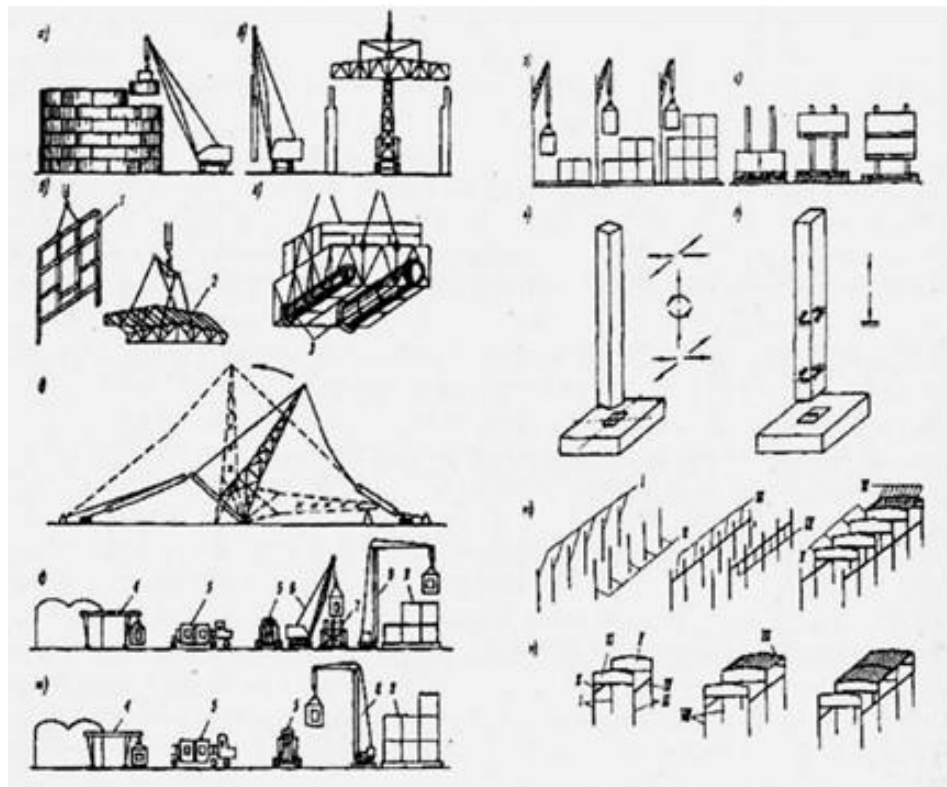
Основные методы монтажа зданий и сооружений:
